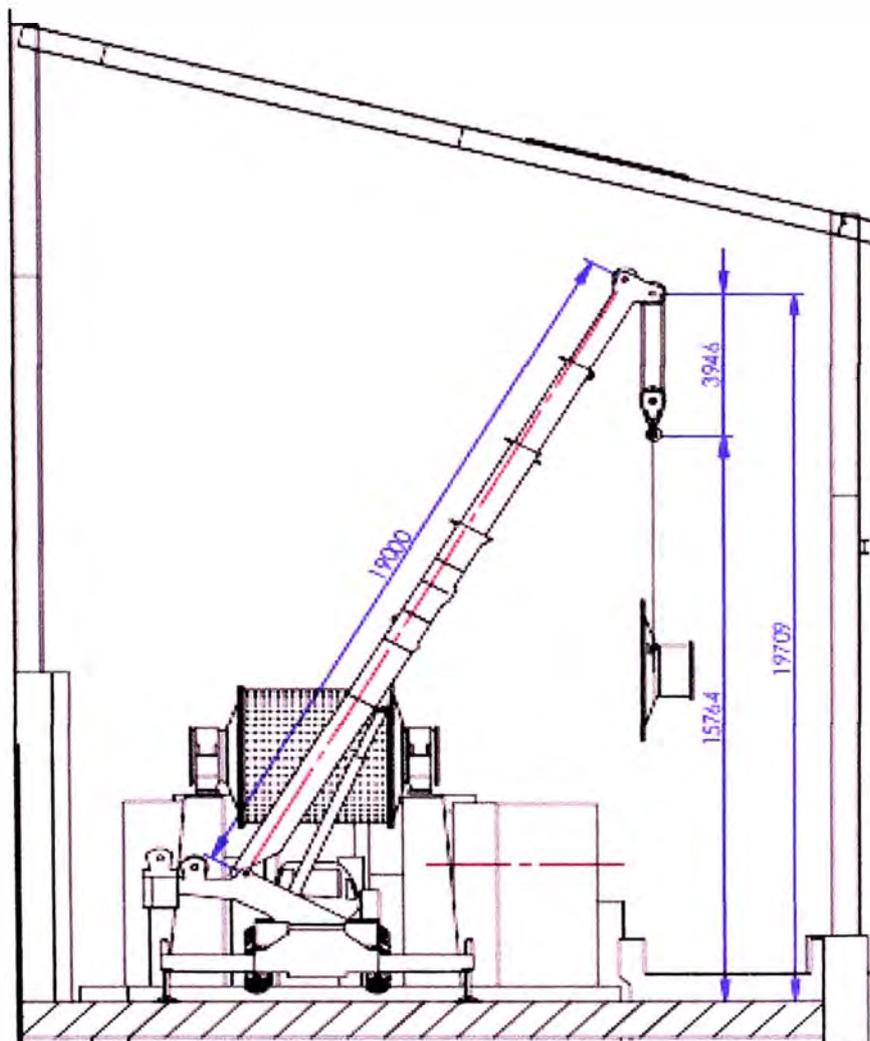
Vista frontal del rigging plan – Montaje de tapas
